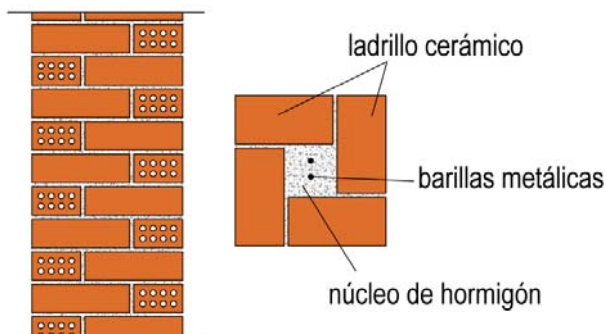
Pilar de ladrillo macizo existente en la vivienda. Fuente propia.
